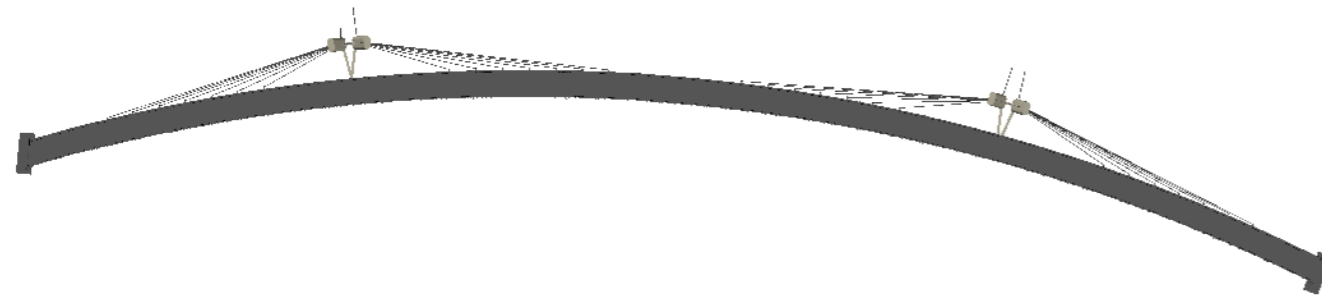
Vista en planta de la pasarela. Fuente: Elaboración propia.
